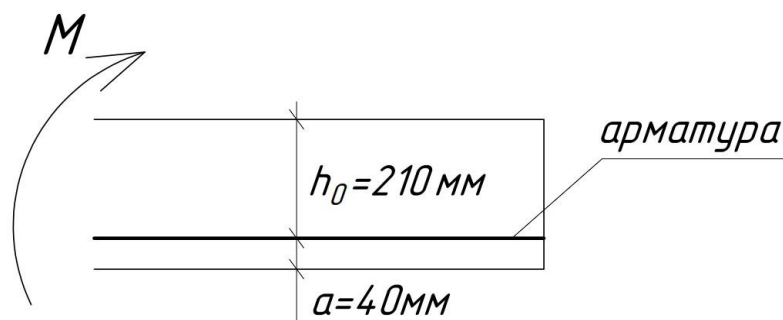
Расчётная схема плиты монолитной плиты перекрытия
